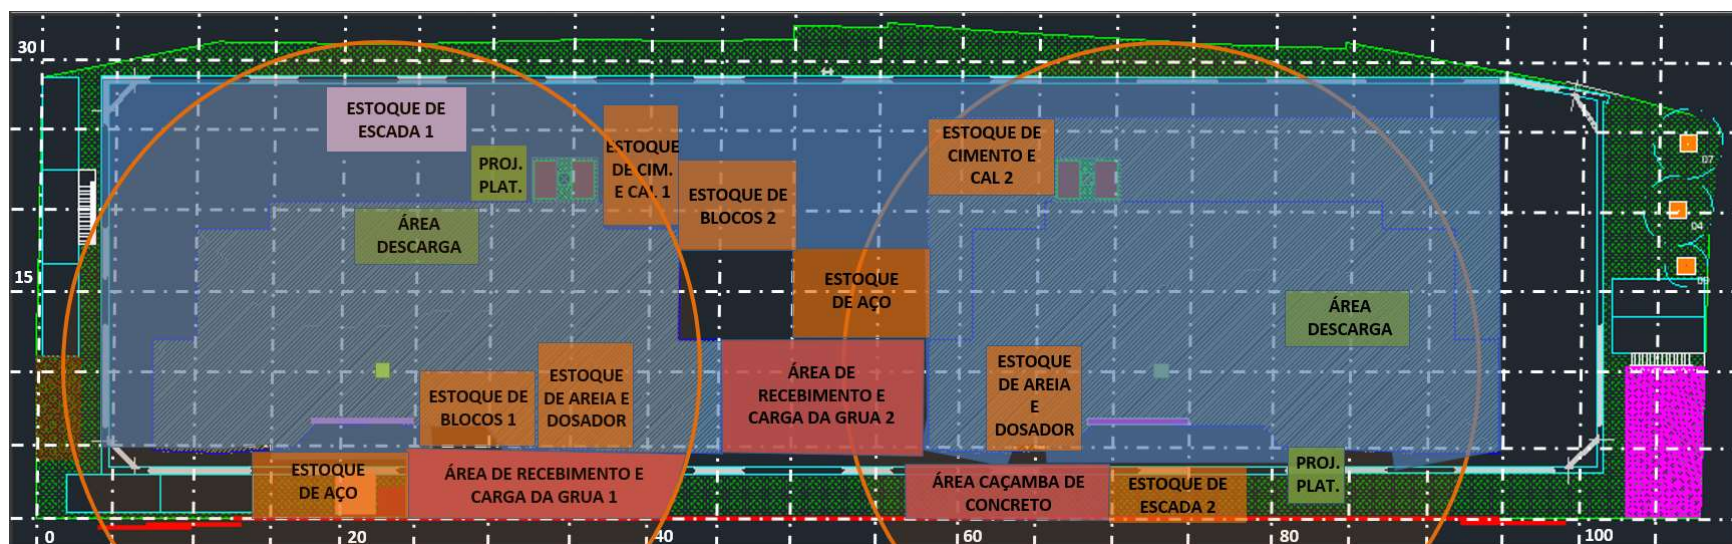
Locação dos elementos do canteiro para análise da Opção 3 (Fonte: Autor)
